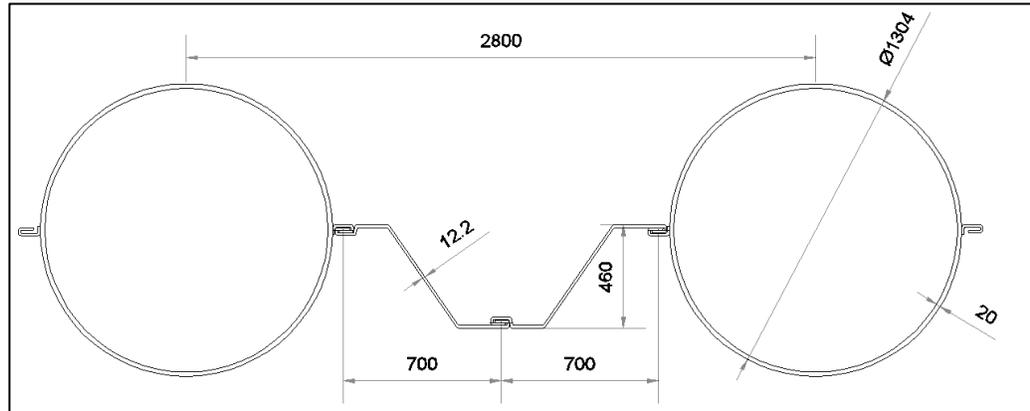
Sección tipo de la tablaestaca a utilizar en la pared interior, del sistema combinado de doble muro.
